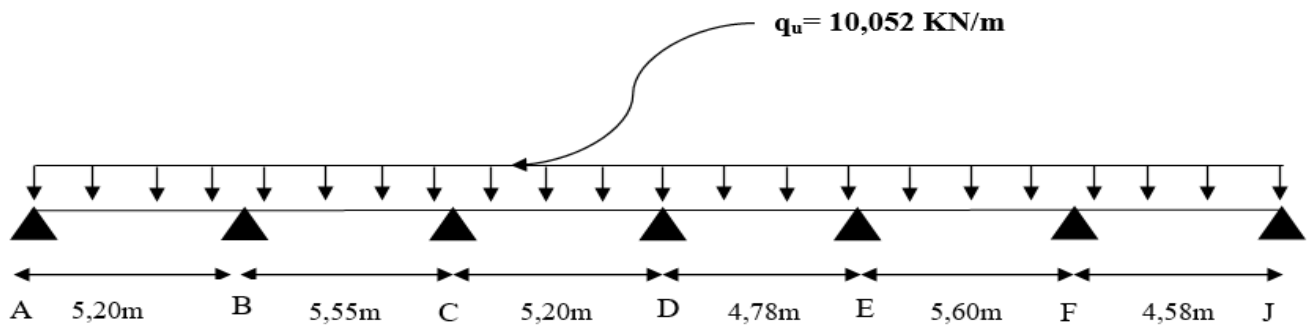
Coupe transversale de la poutrelle à 6 travées
